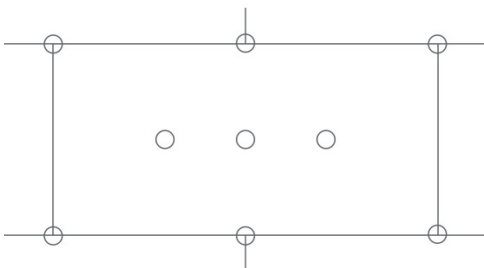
Panneaux de dimensions 1 000 x 500 mm – plans de chevillage en plein (espacement entre chevilles ≥ 150 mm)
